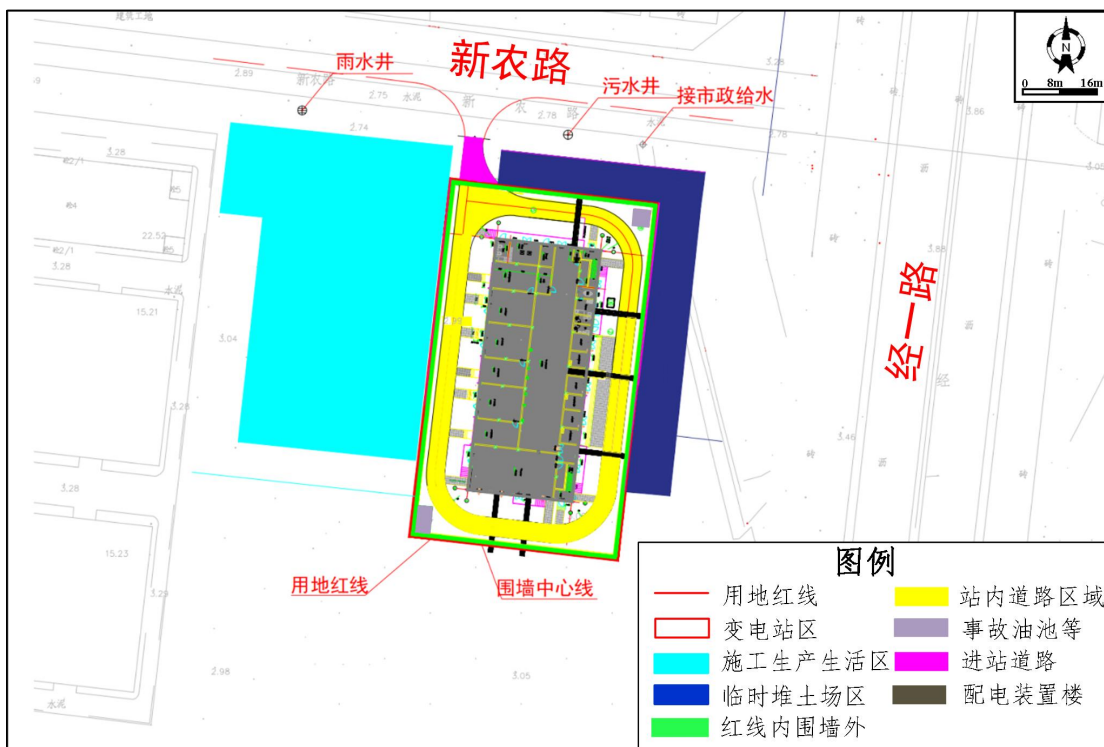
澄桥 110 千伏变电站工程总平面布置图
